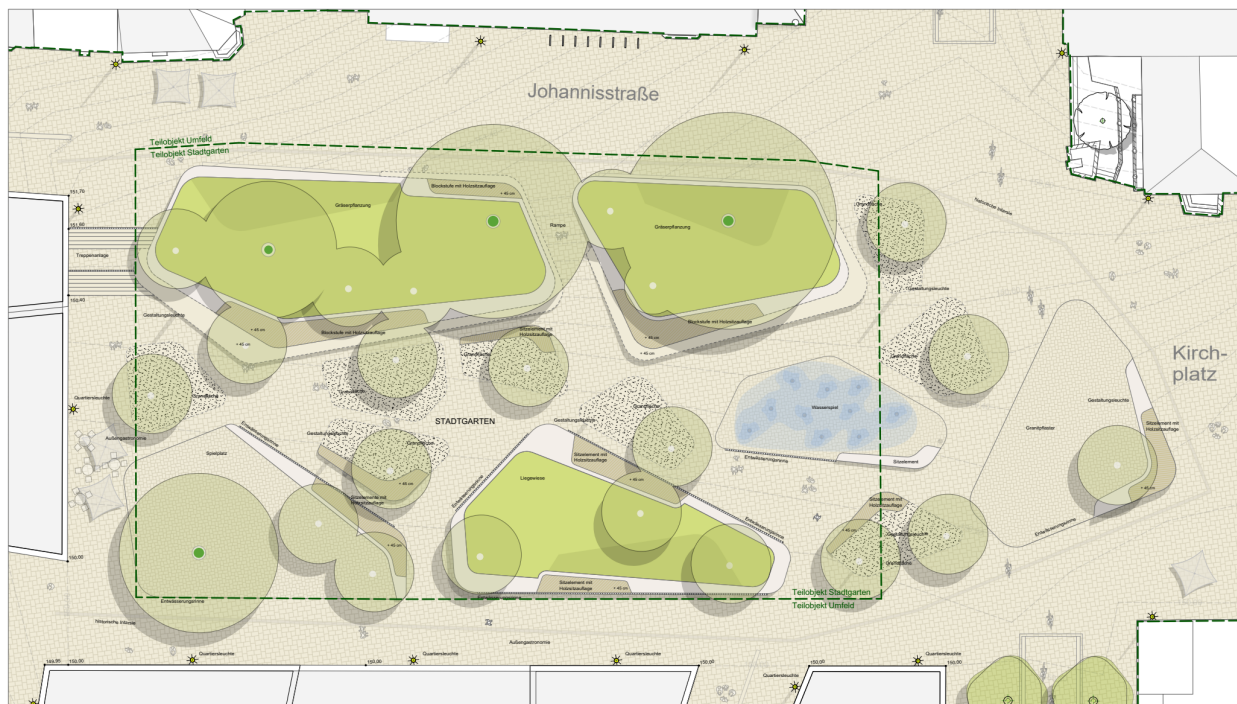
Konzept Neuer Stadtgarten, Lageplan
